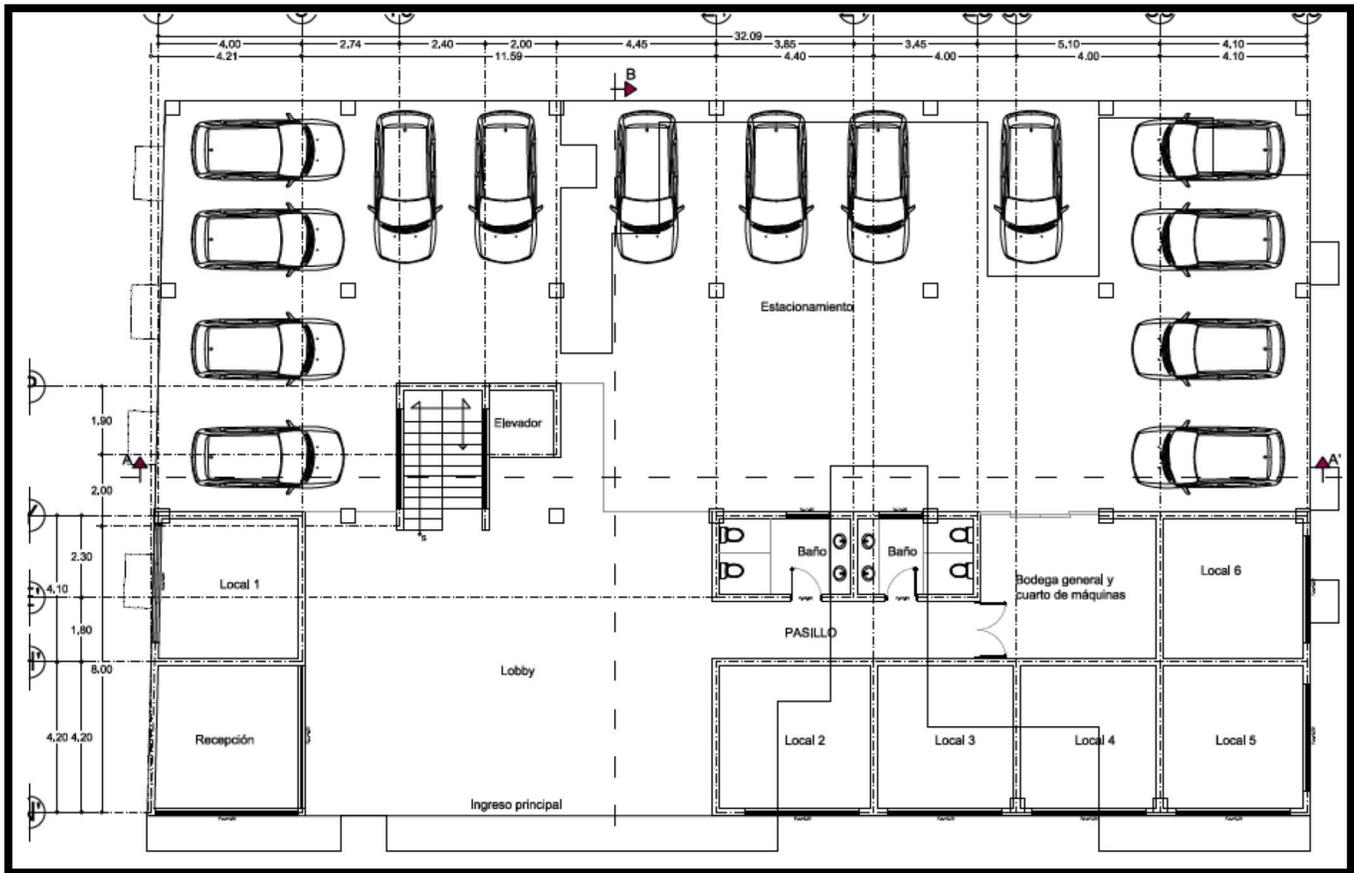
Planos generales de planta baja del proyecto "CONDO-HOTEL" y distribución de las superficies.
